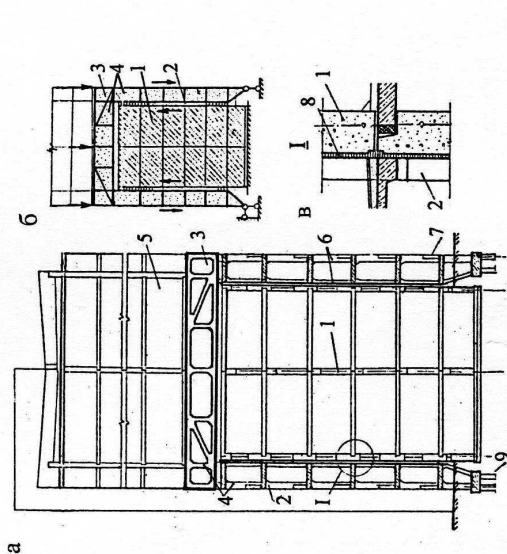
Реконструкция крупнопанельного пятиэтажного дома с ненагружающей многоэтажной надстройкой
